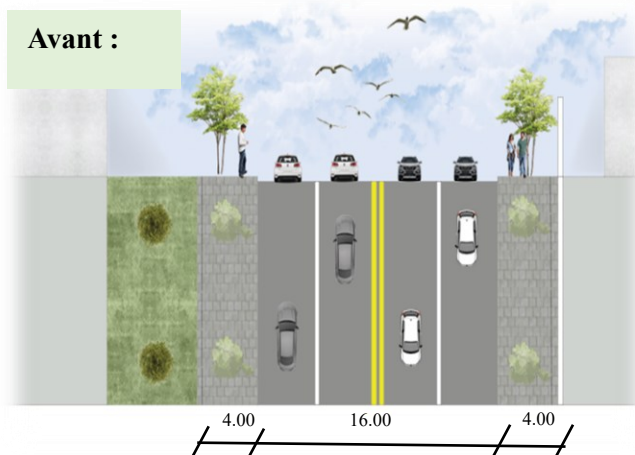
plan et coupe de l'avenue Chabane Ahcene avant l'intervention.
